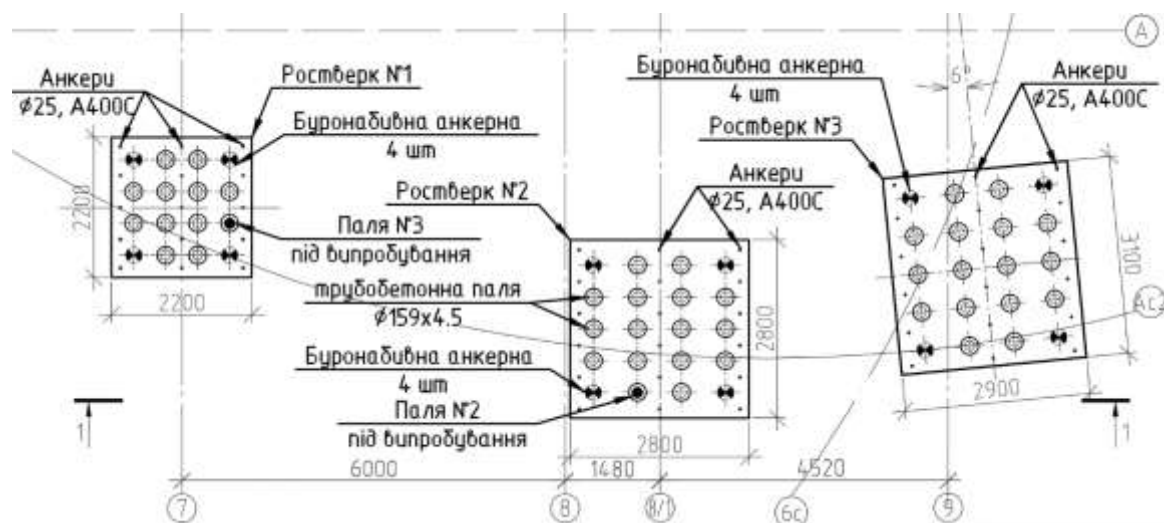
Схема фундаментів під прибудовану частину будівлі
